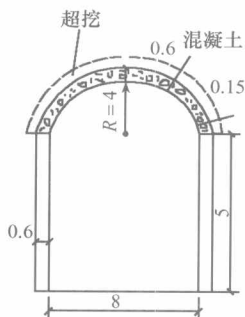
混凝土拱部衬砌示意图 (单位: m)
